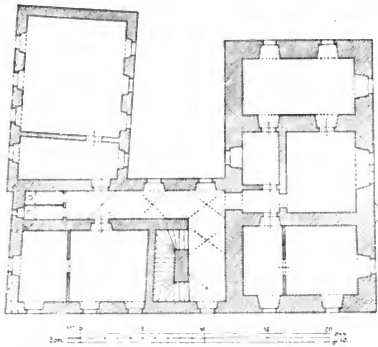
Píbram. Das ehemalige erzbischöfliche Schloss. Grundriss.
